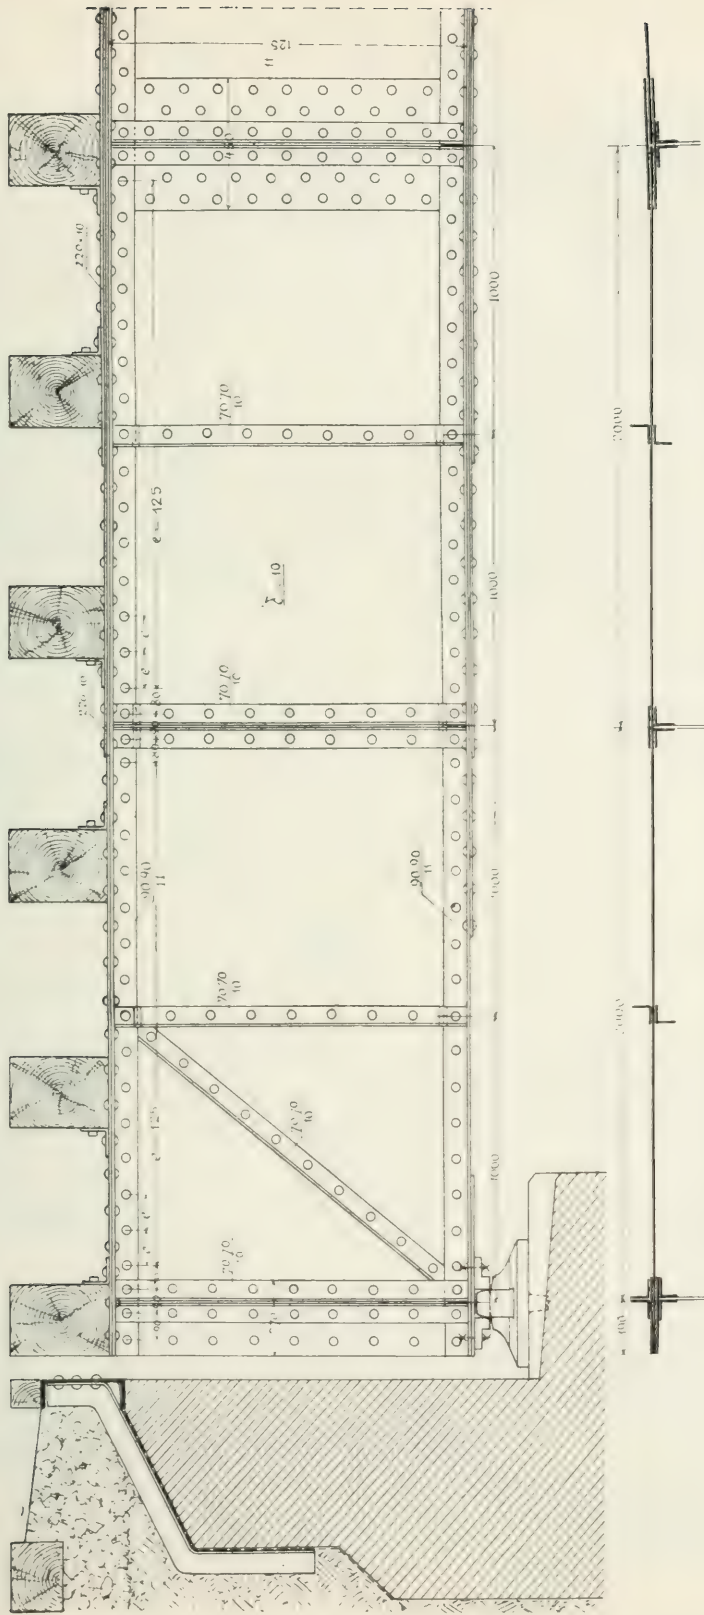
Eisenbahn-Blechbrücke mit oben liegender Fahrbahn von 15 m Stützweite.
